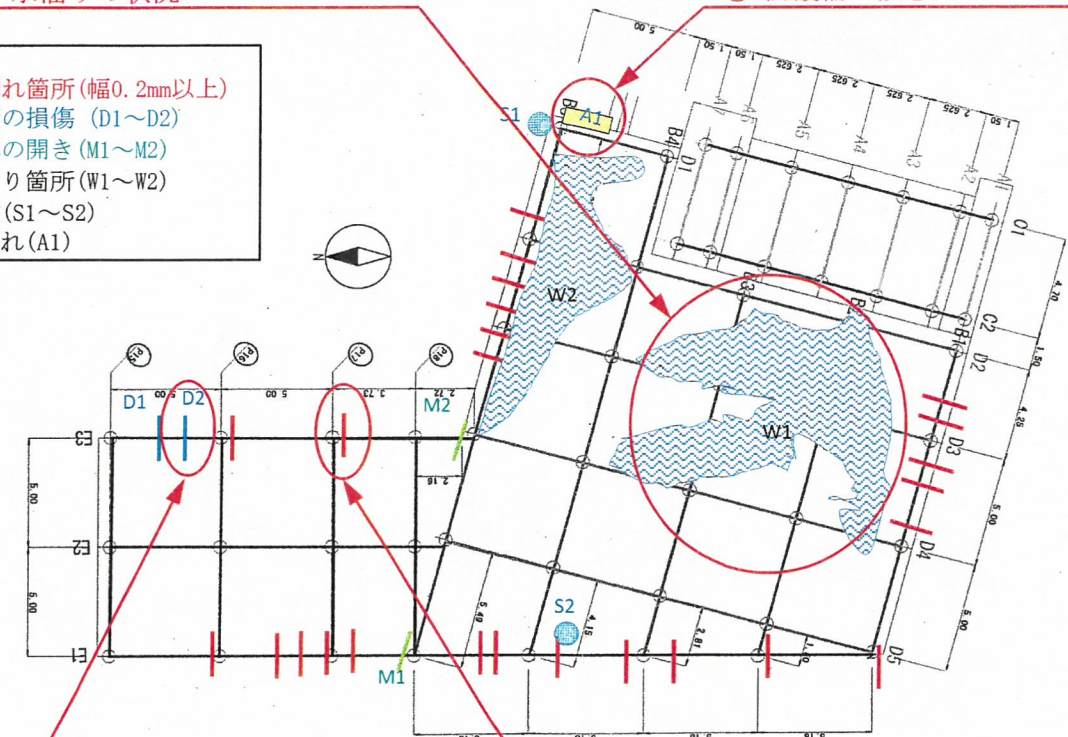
搬出入施設・車両乗降部 平面図 (上部工)
